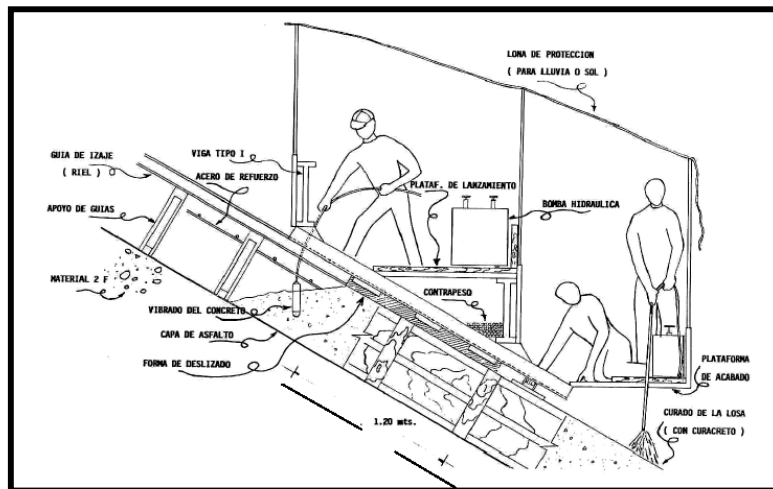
Cimbra deslizante utilizada en la construcción de la cara de concreto
